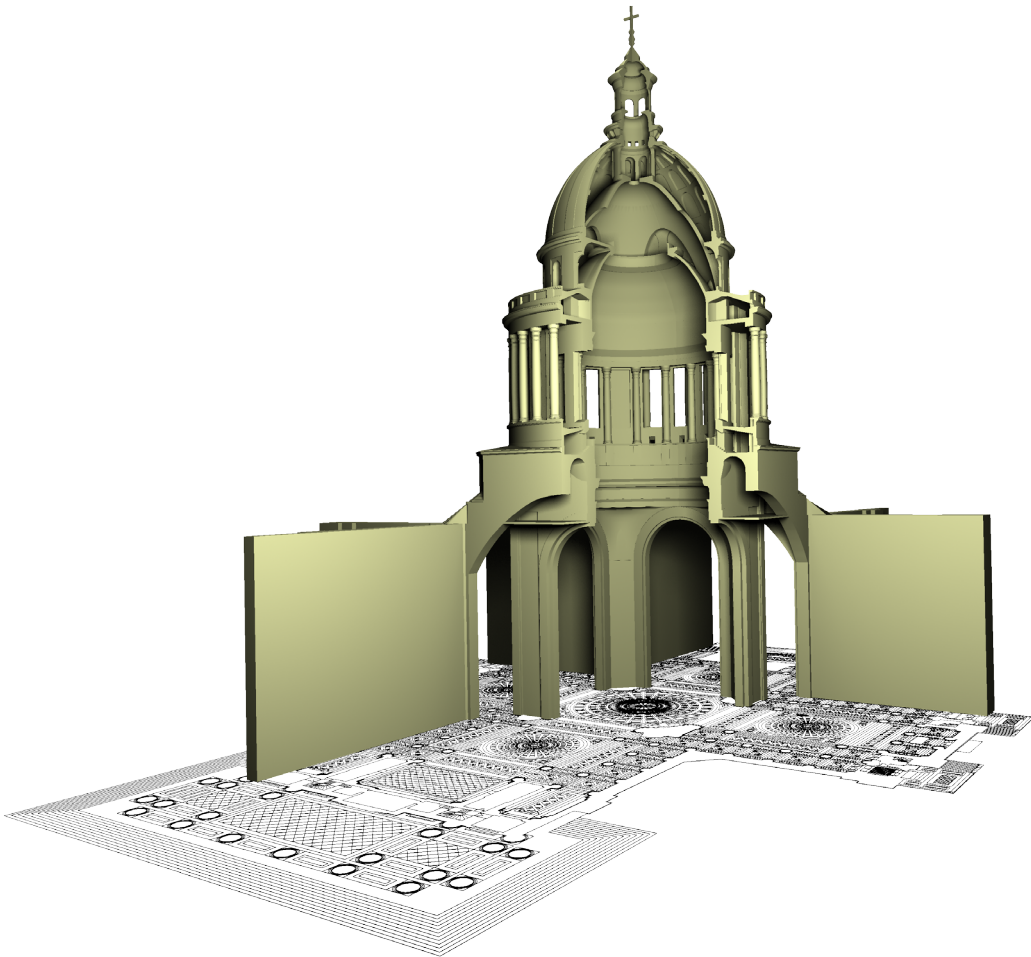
Ricostruzione tridimensionale dei primi due sistemi strutturali. Spaccato assometrico delle cupole e dei grandi archi.
